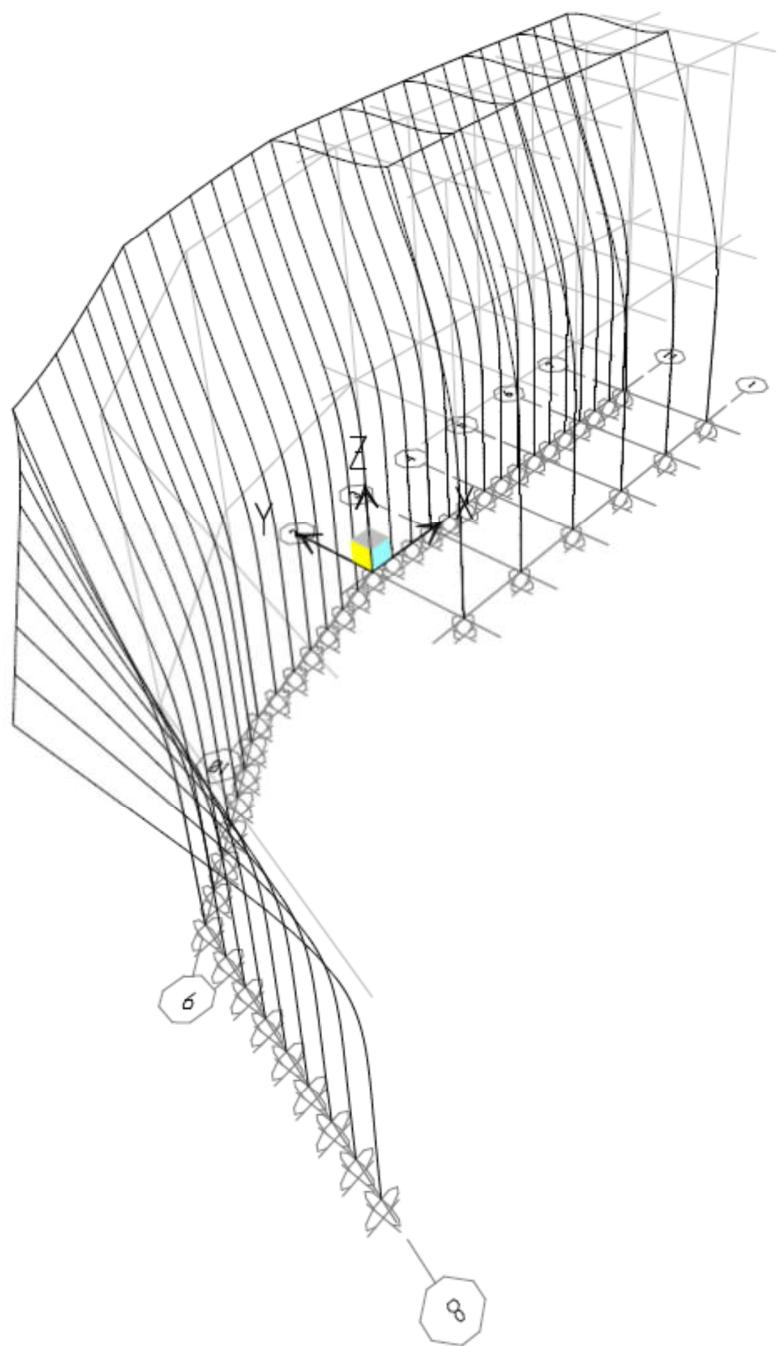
Skema e deformimit të ramës me pilota 2, modelimi FEM
